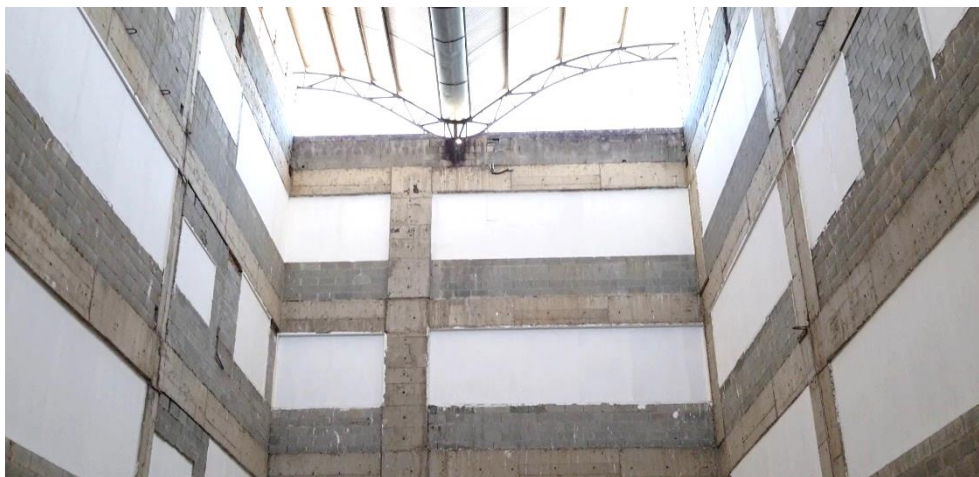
Deambulação - Aspecto Existente (foto Secretaria Obras)
